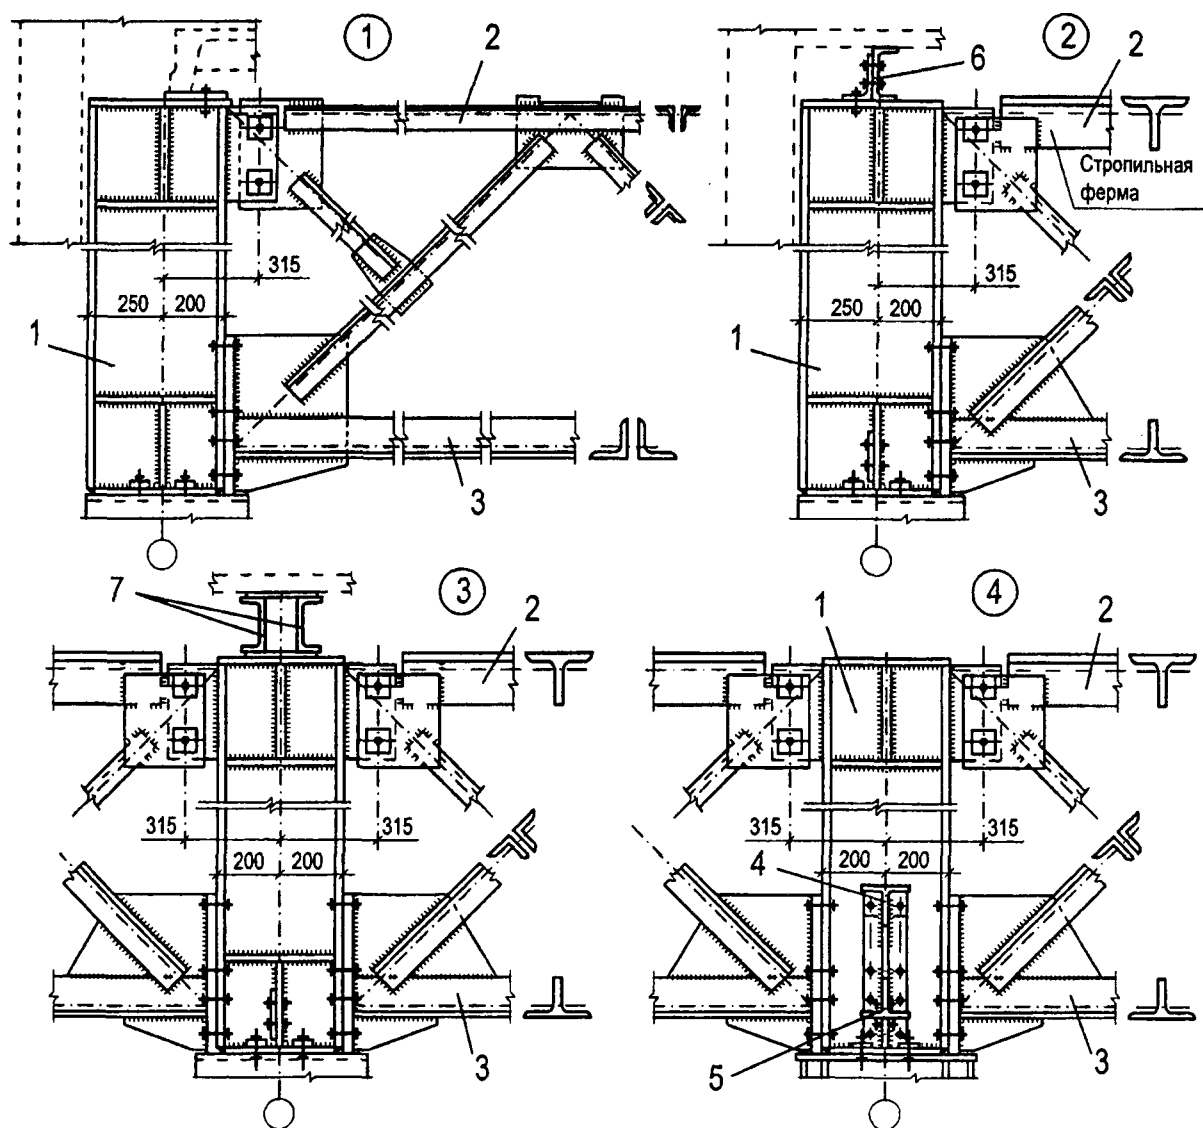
Узлы стропильных ферм из парных уголков и широкополочных тавров (начало):
